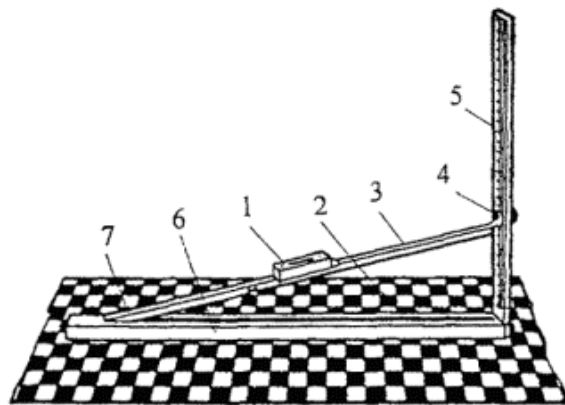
Прилад для перевірки ухилу: 1 – рівень; 2 - поздовжній паз; 3 – рухлива планка; 4 – візир; 5 – рейка зі шкалою; 6 – нижній брусок; 7 - нерухомий шарнір
